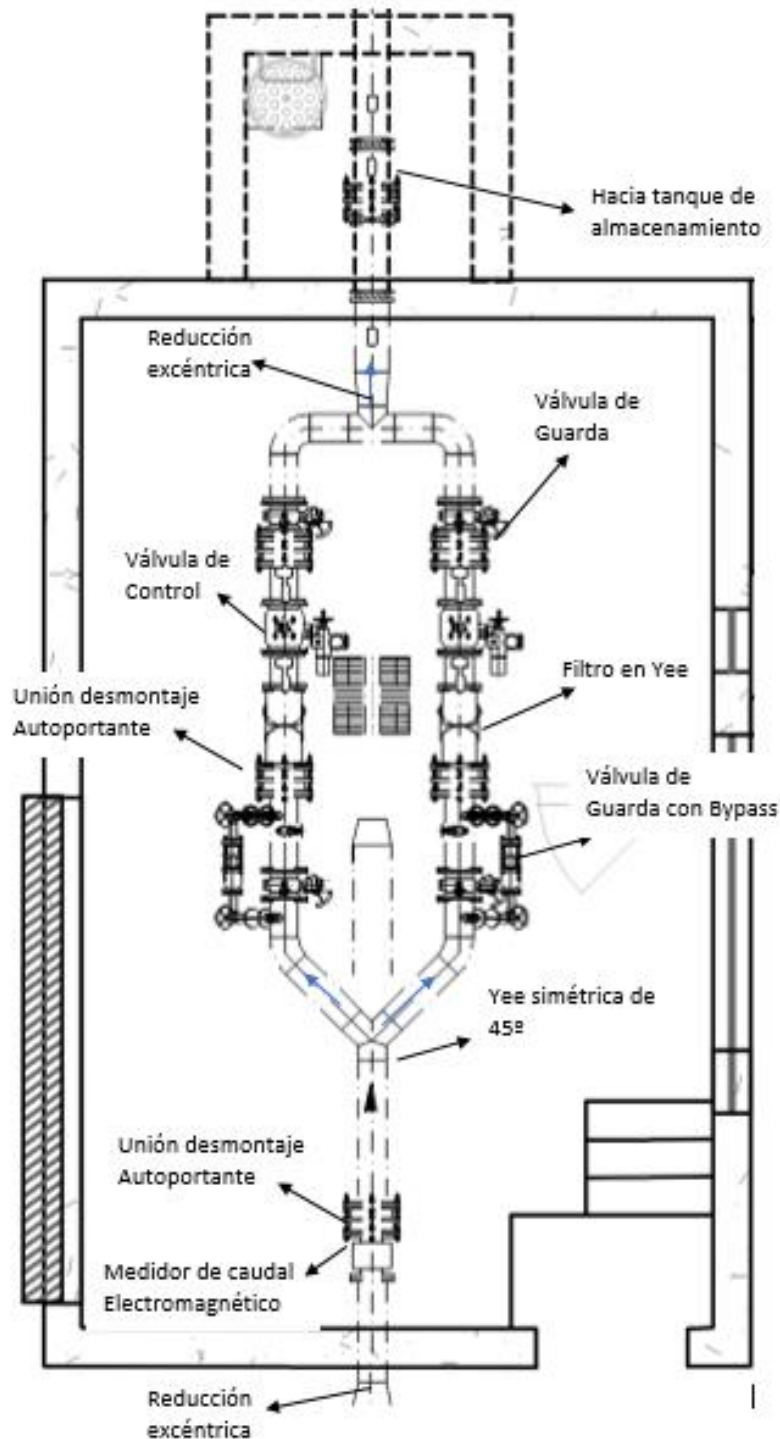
Configuración tipo de una Estructura de Control Vista en Planta
